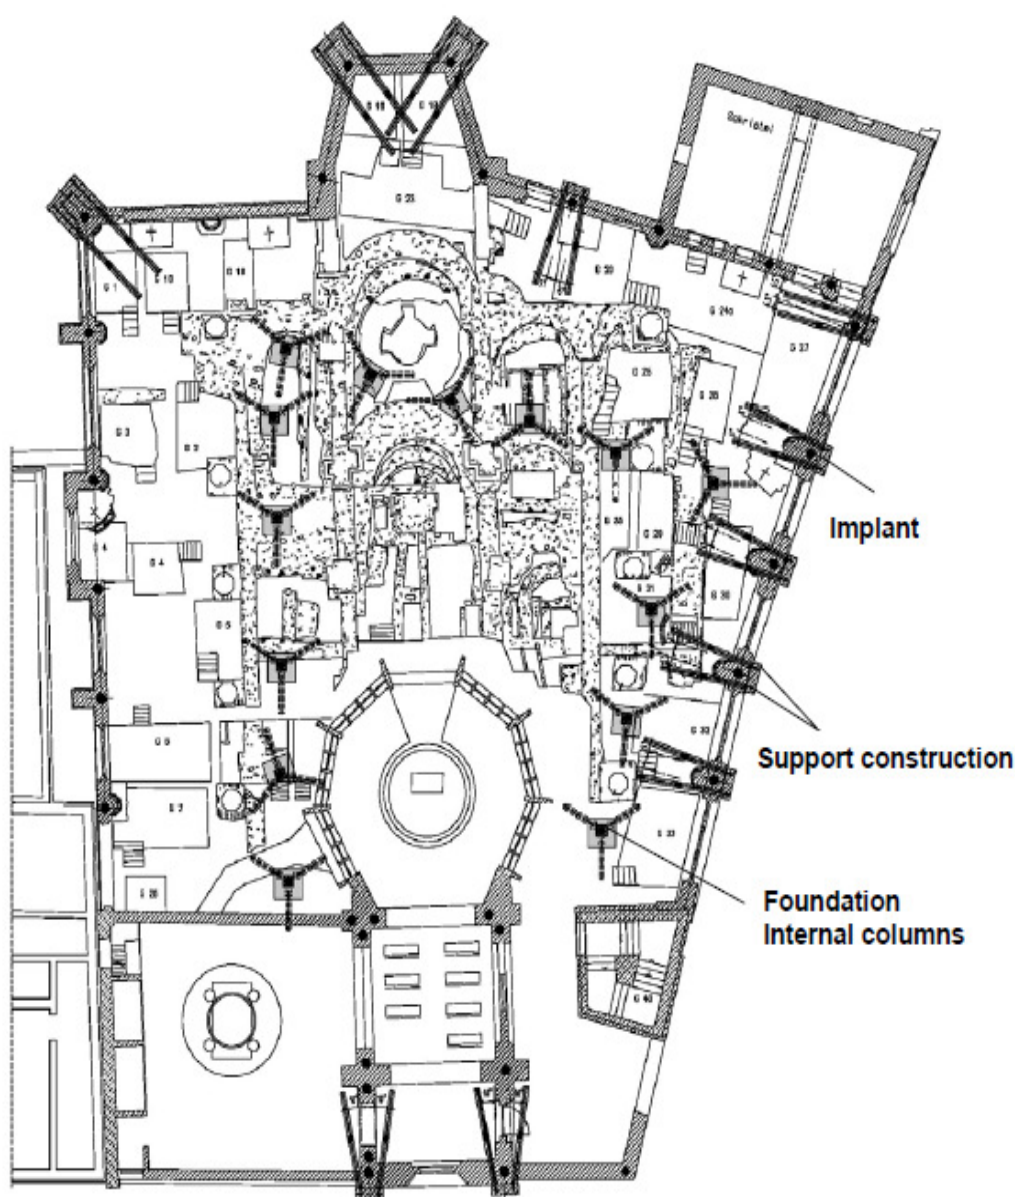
Vista da planta de fundações e do reforço das paredes exteriores (Dietz e Schürman, 2006)
